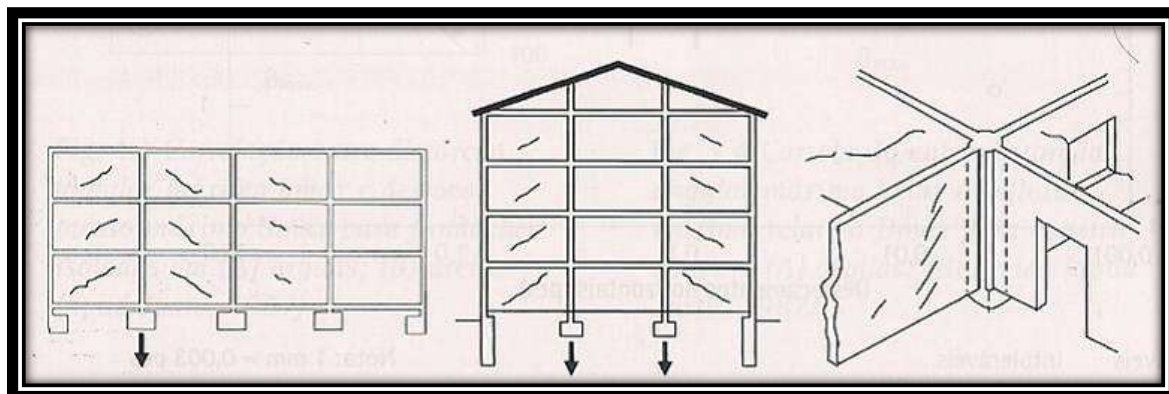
Fissuras típicas causadas por recalque de fundações de pilares internos
